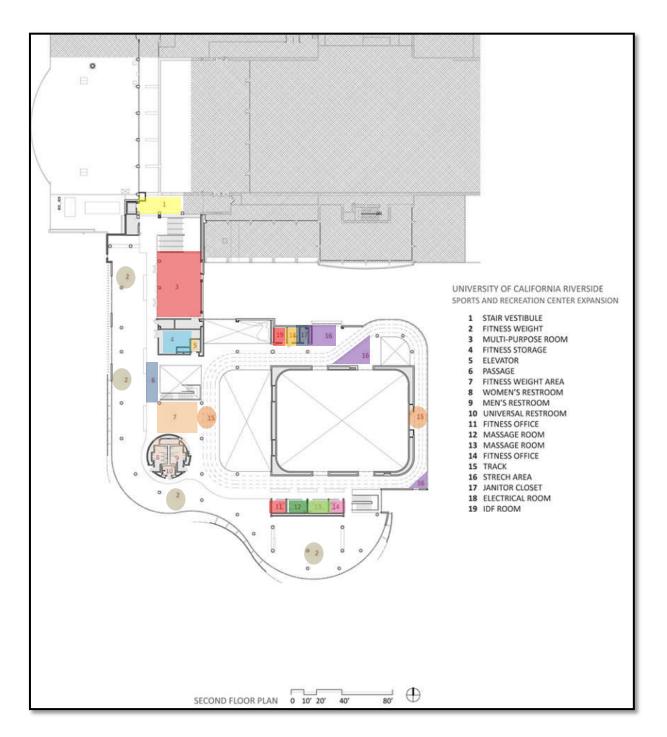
zoning الطابق الأول. المصدر: https://www.archdaily.com بتصرف الباحثتين.
